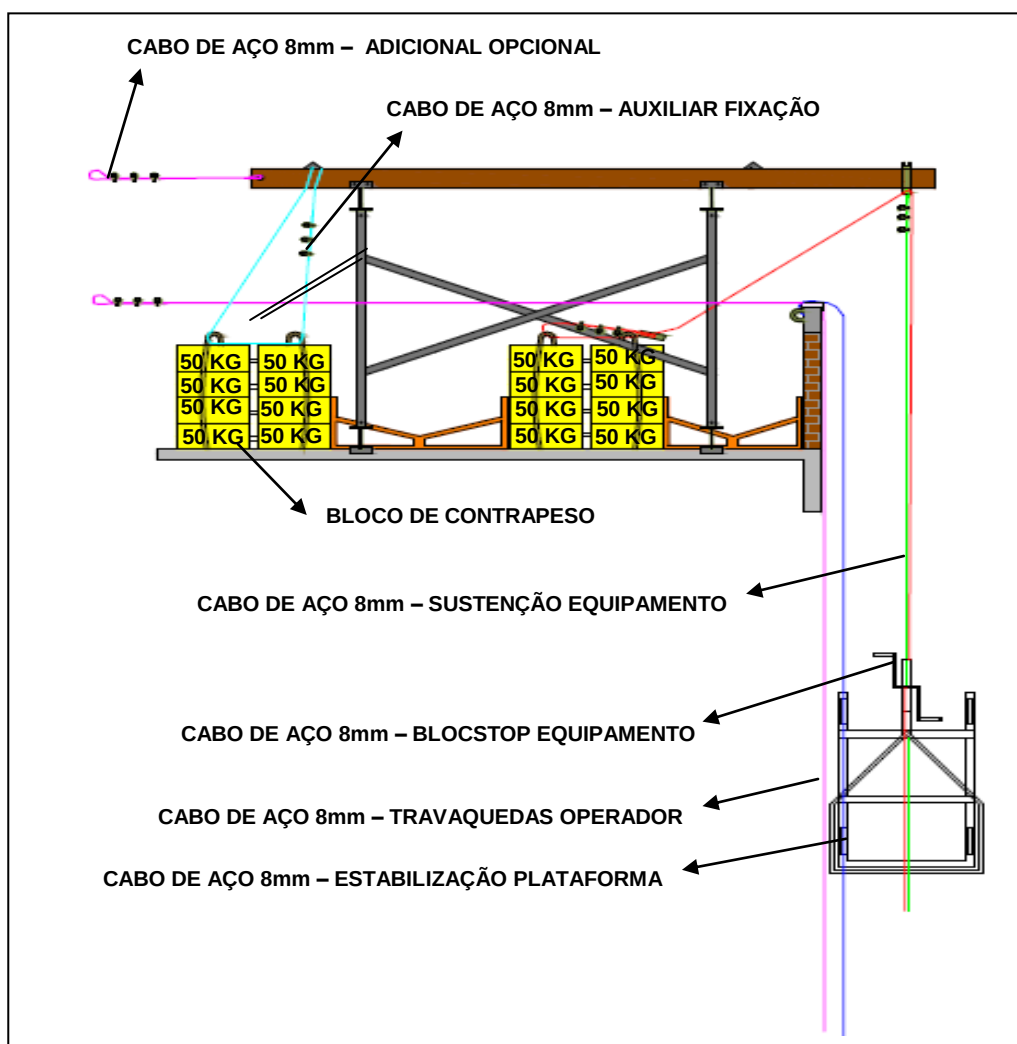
Fixação com perfil metálico apoiado em torre tubular com bloco de contrapeso
